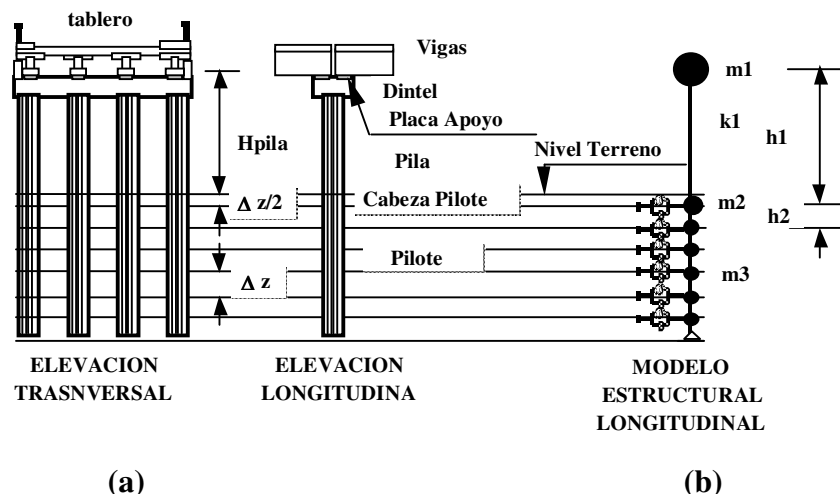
(a) Elevación longitudinal y transversal de una cepa-pilote; (b) Modelo estructural propuesto.
